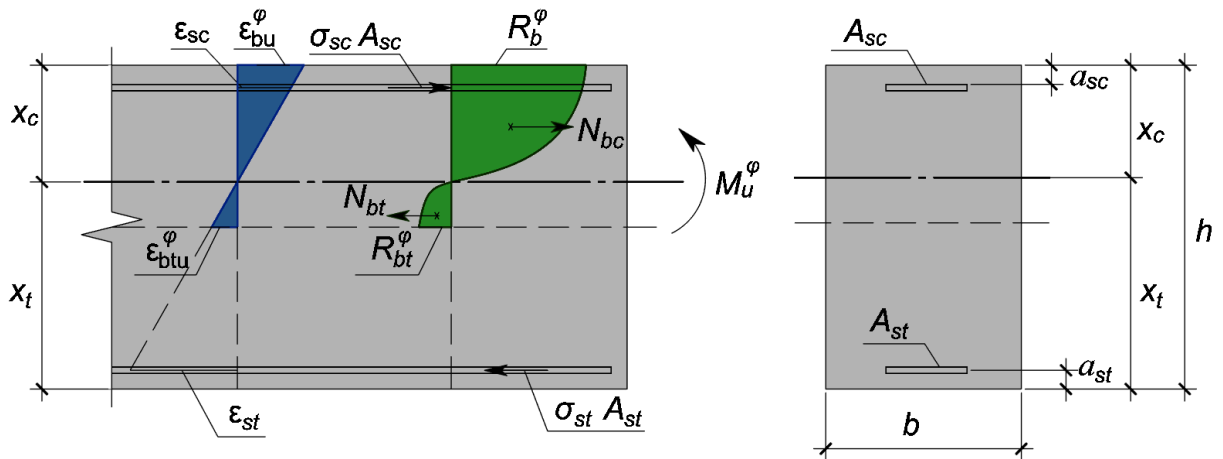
Расчетная схема напряженно-деформированного состояния изгибаемого железобетонного элемента прямоугольного сечения непосредственно перед исчерпанием его прочности
